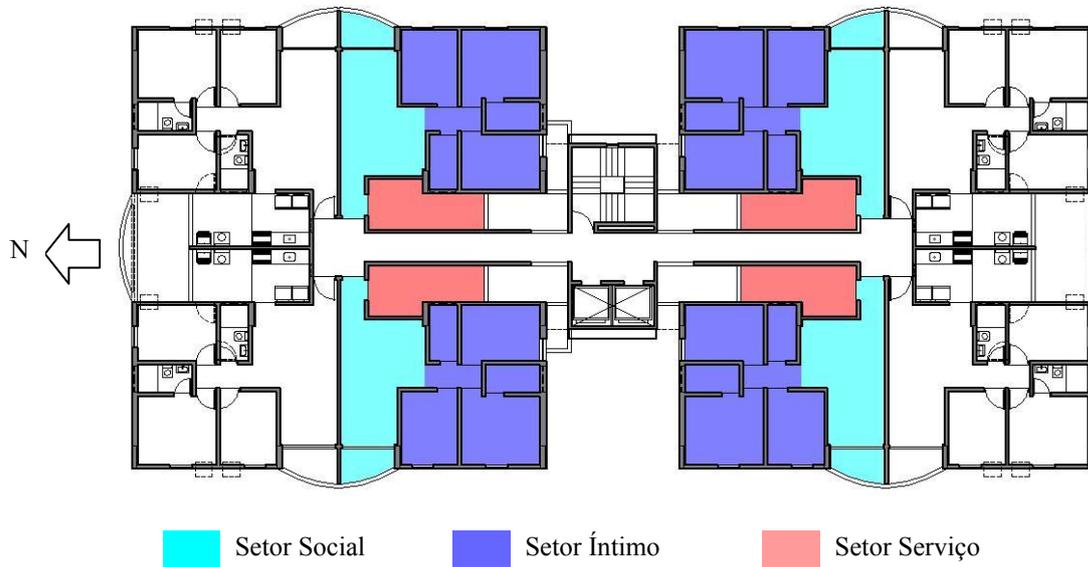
Planta baixa da edificação em estudo com esquema de setores.
